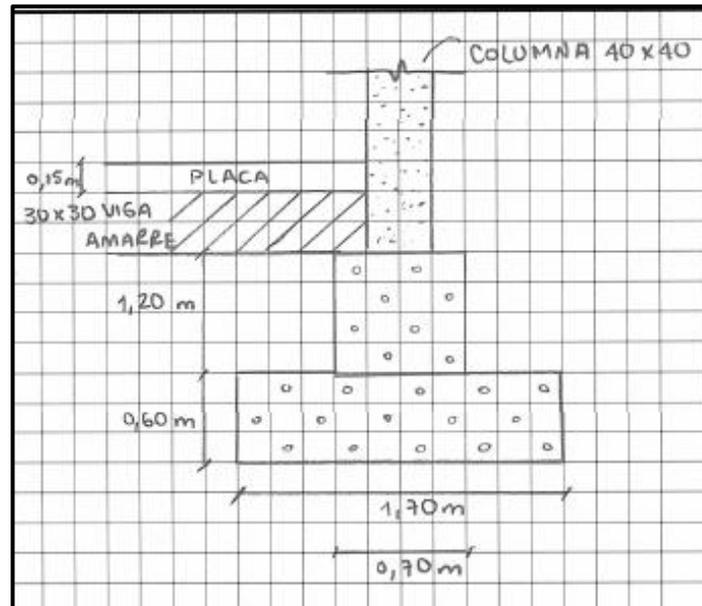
Detalle de la cimentación existente en el edificio de la sede del SENA – Edificación No. 2 Bloque Aulas y Talleres.
